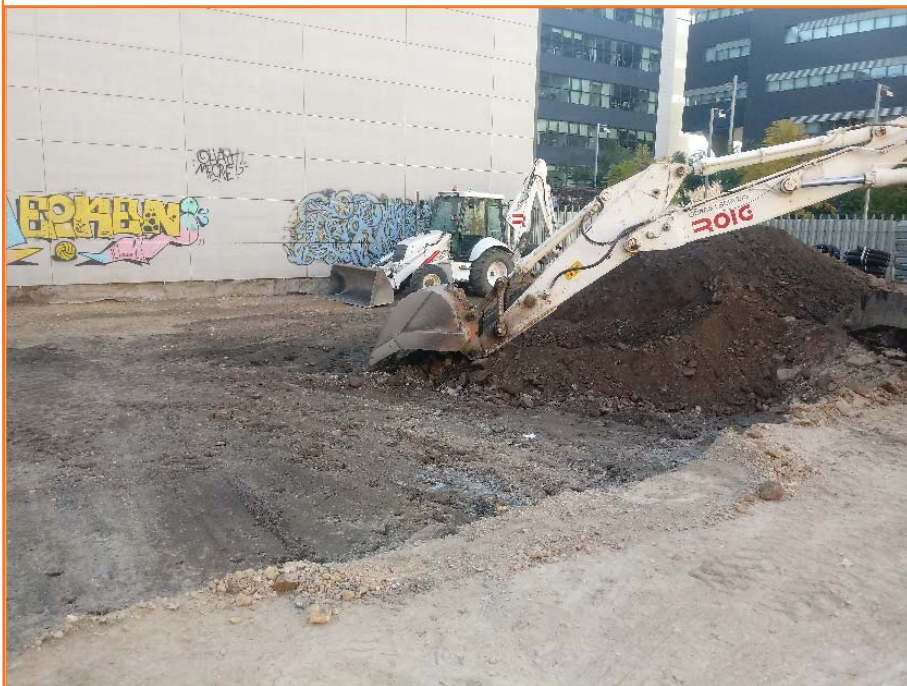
Treballs de control dels rebaixos a la meitat oest del solar.
